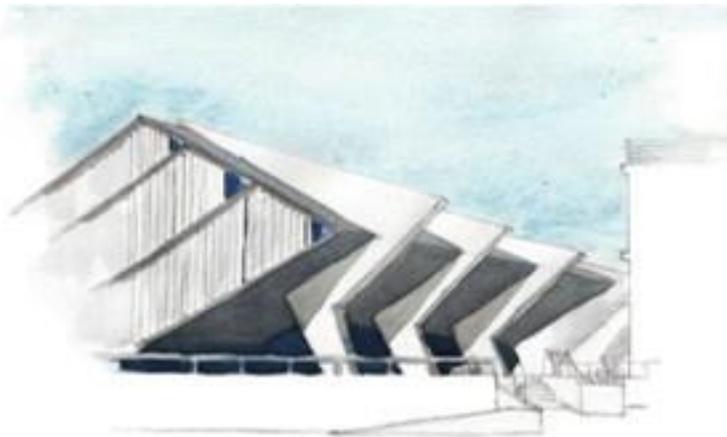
Referente arquitectónico (Coliseo Sede Chorrillos) y concepto para la propuesta de la fachada (remos).
